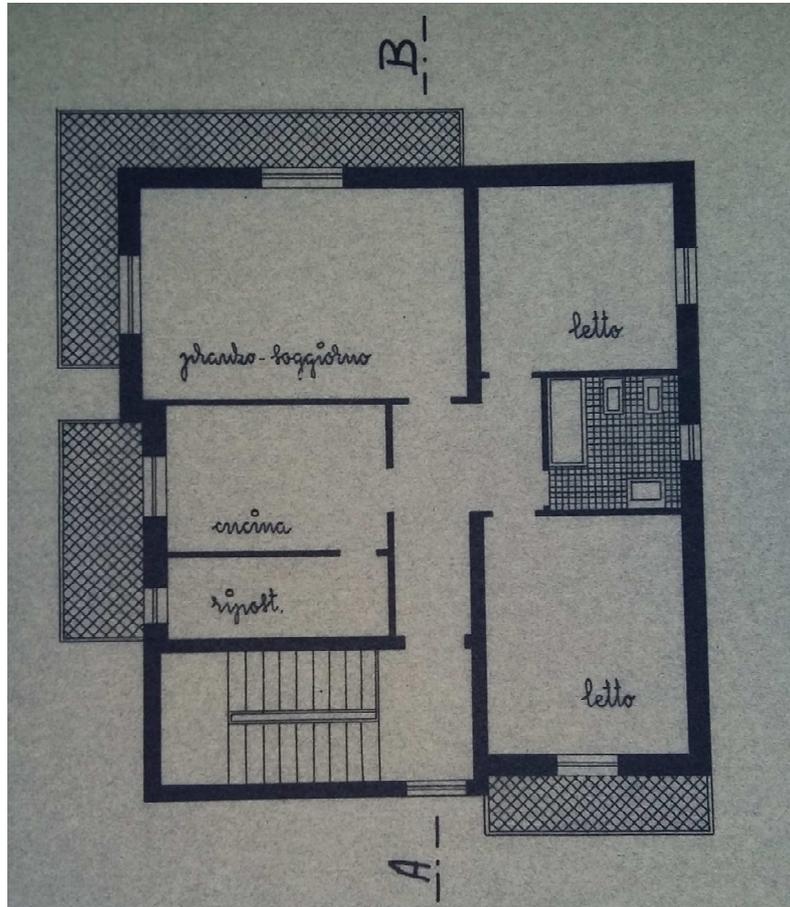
Pianta piano sopraelevato dell'edificio campione.
